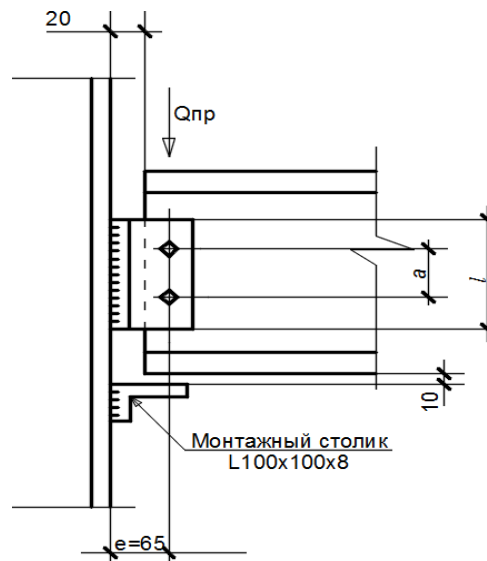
Шарнирный узел крепления балок к колоннам на 2-х болтах
